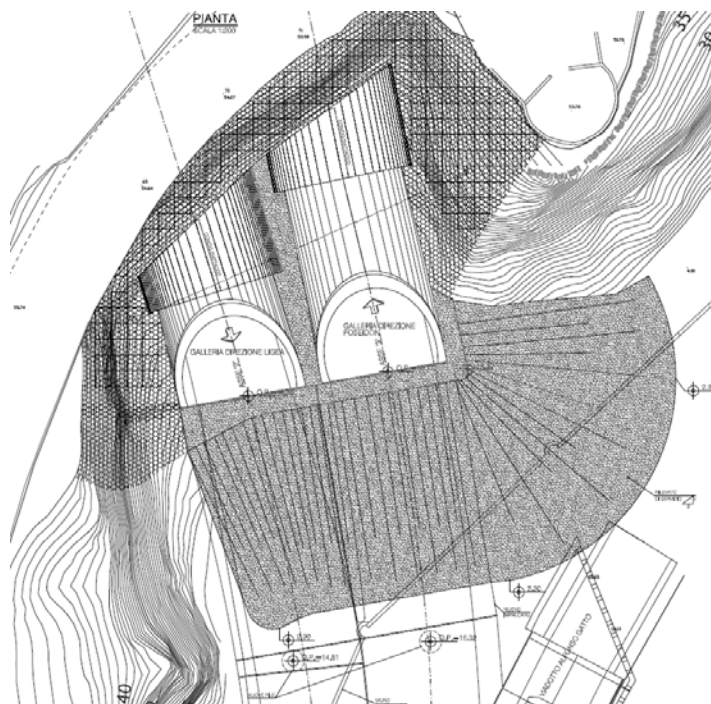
Sistemazione imbocco Ligea (pianta) da PD
